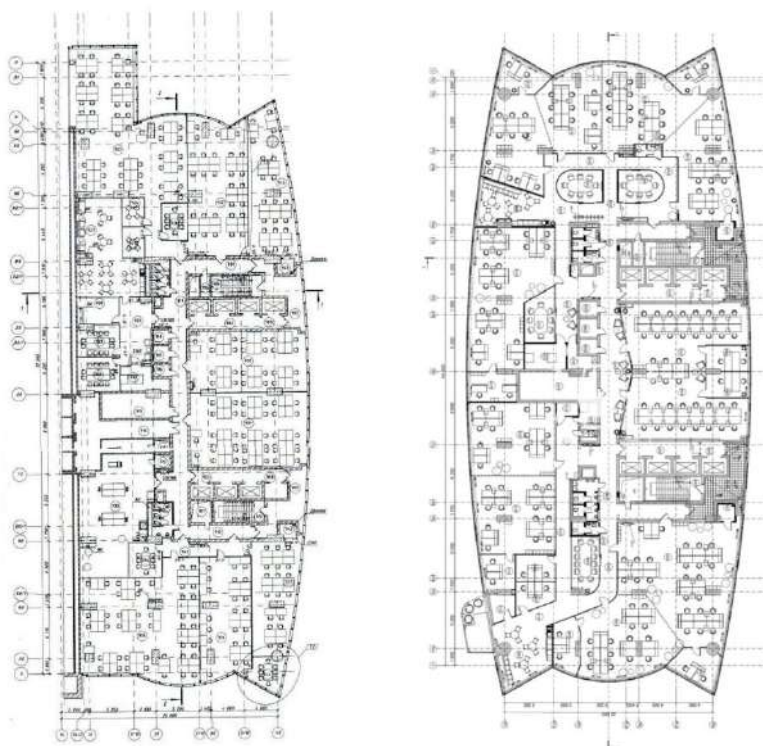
а) - план 8-го поверху; б) – план 12-го поверху [37]
